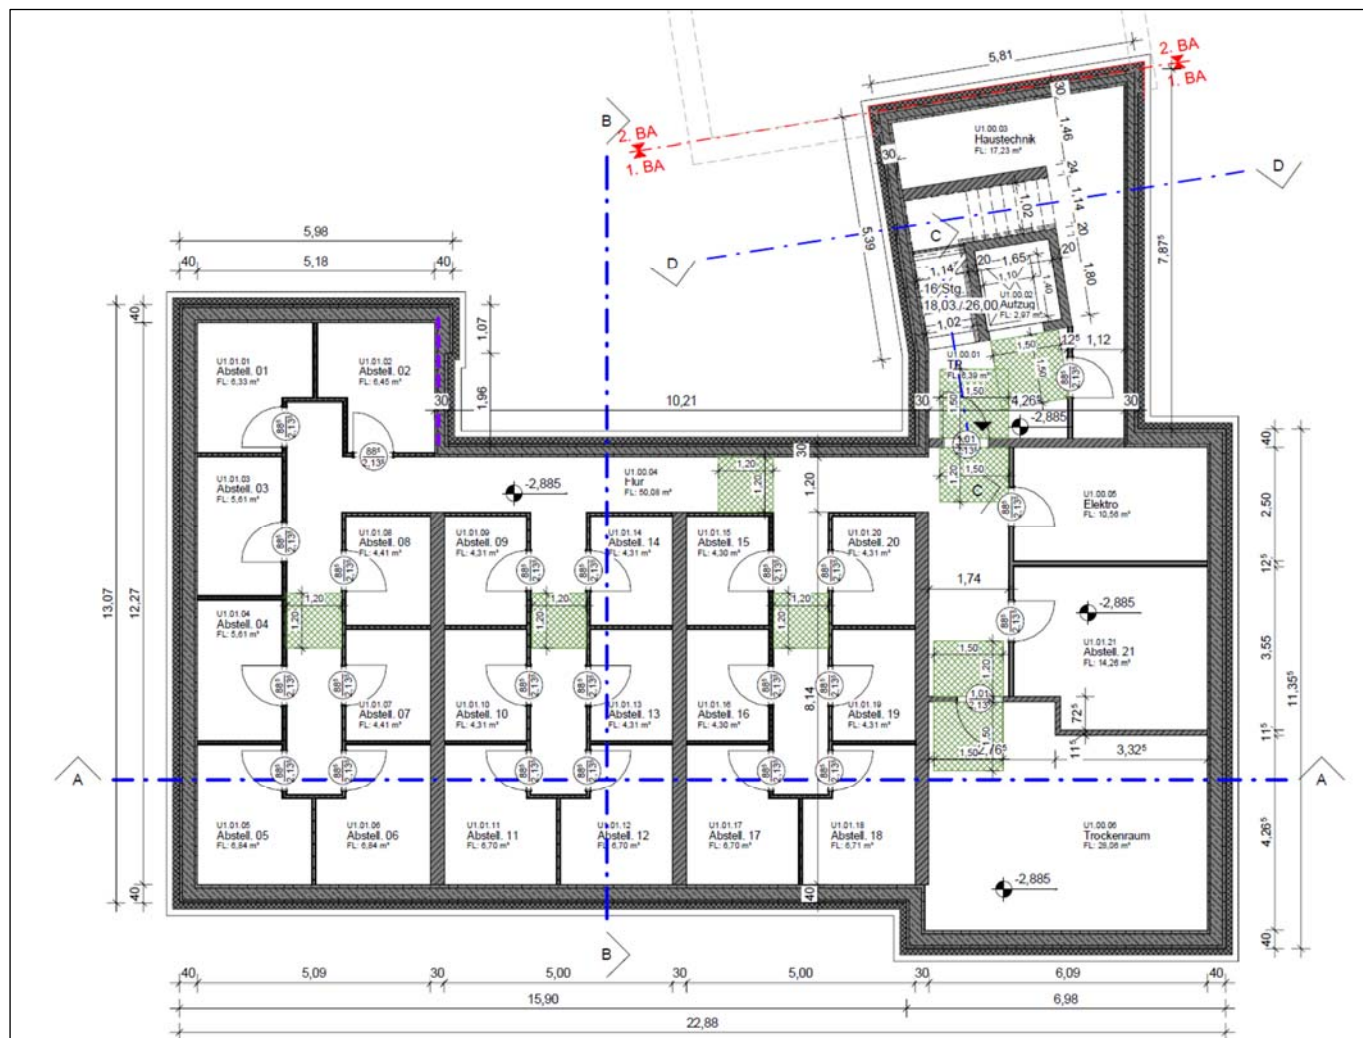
Grundriss UG, 1. BA (2. BA nicht unterkellert)
